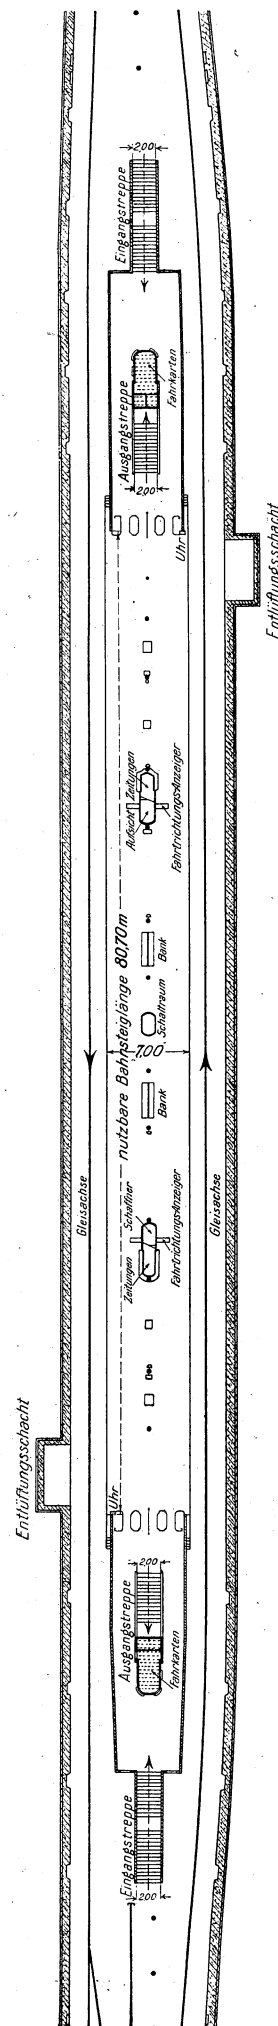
Normale Haltestelle mit je zwei Treppen (Grundriß). Maßstab 1 : 625.
